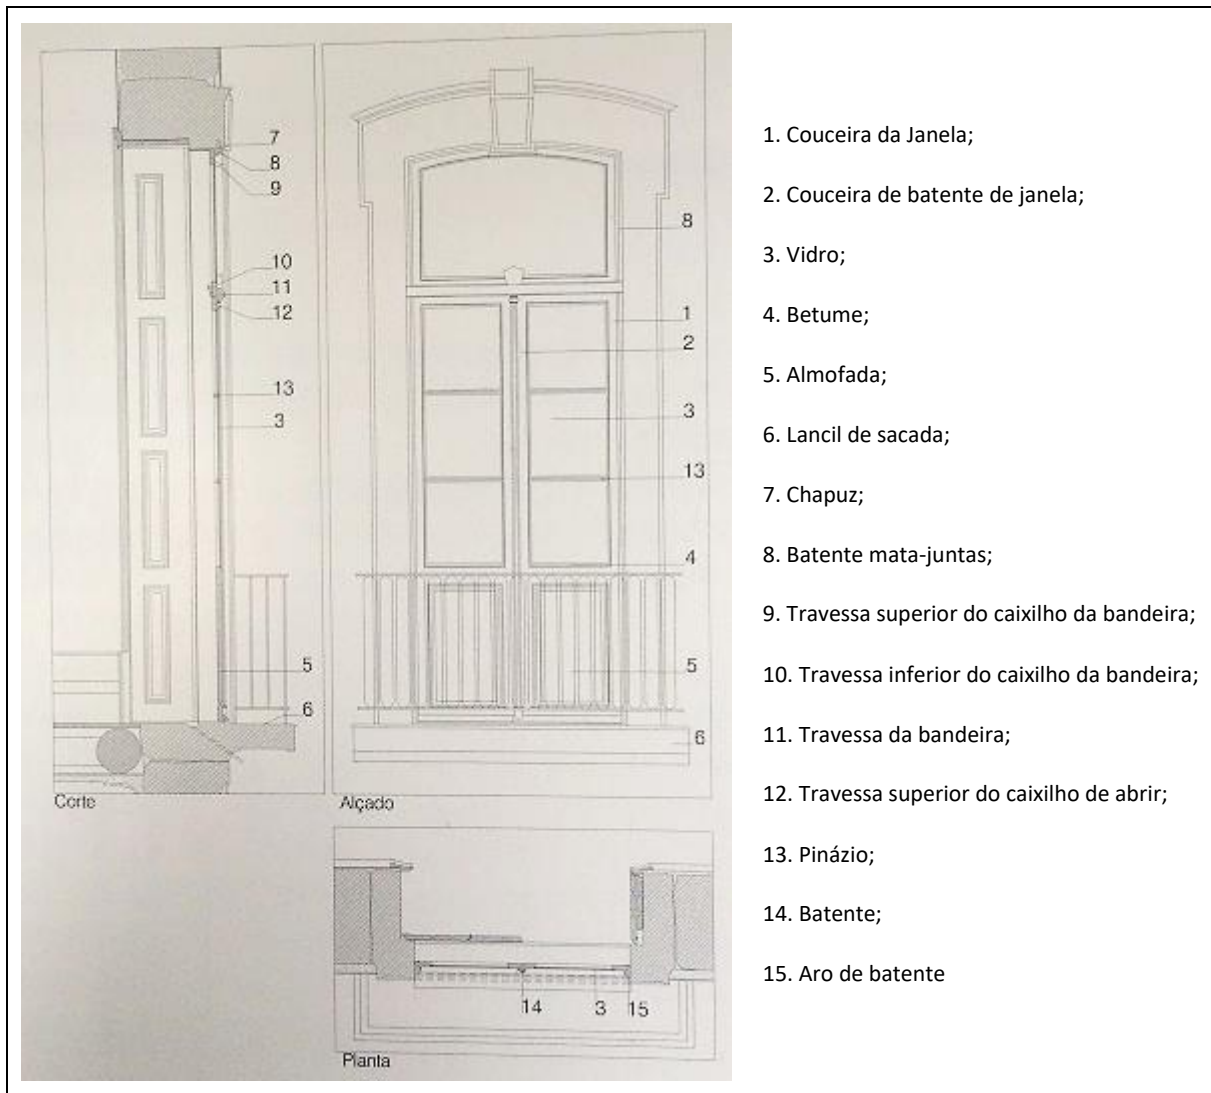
Alçado, planta e corte tipo de janela de sacada de batente [1]
